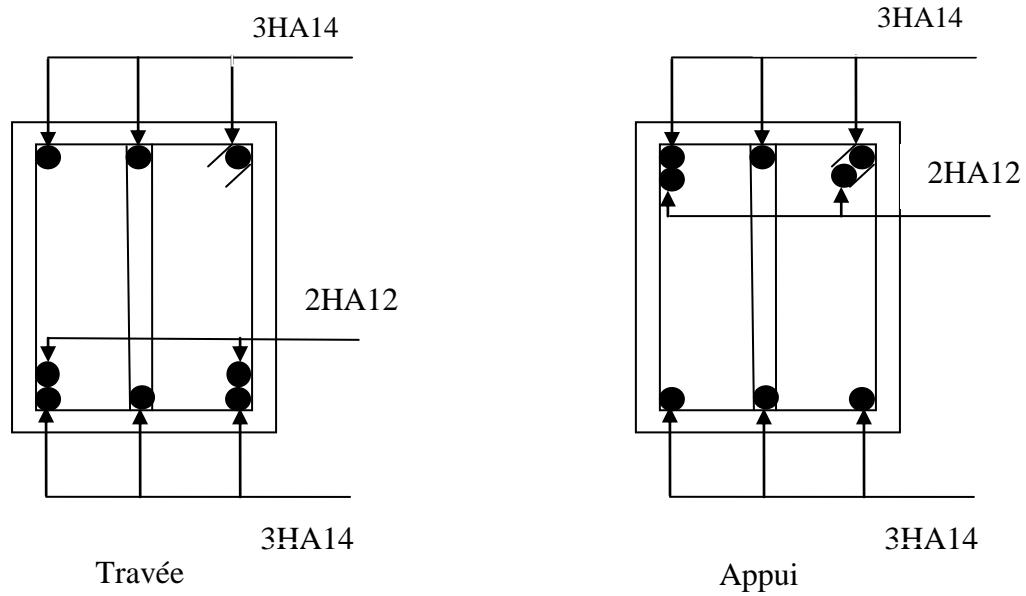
Schéma de ferrailage de la poutre secondaire (30×40) de RDC et les étages courants
